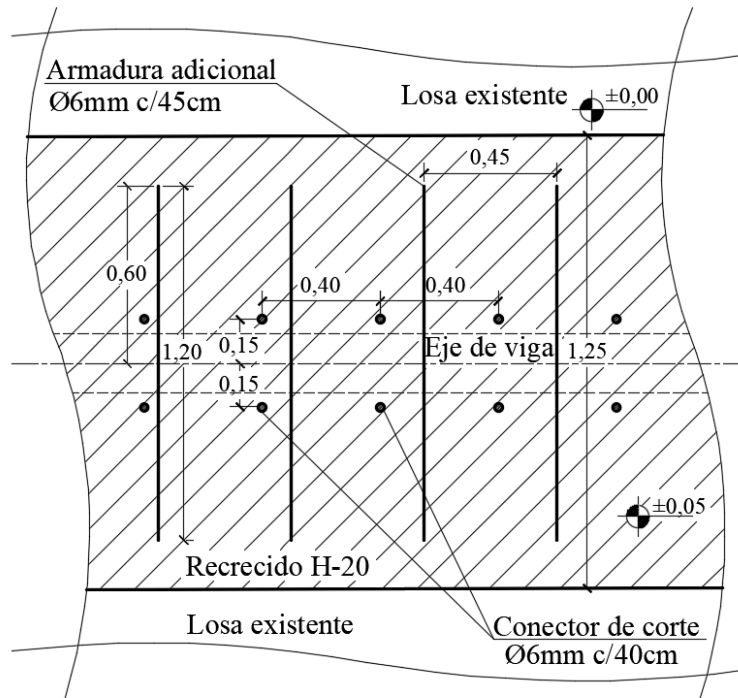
Armadura adicional en recrecido de hormigón Apoyo Losas L2/L7.
